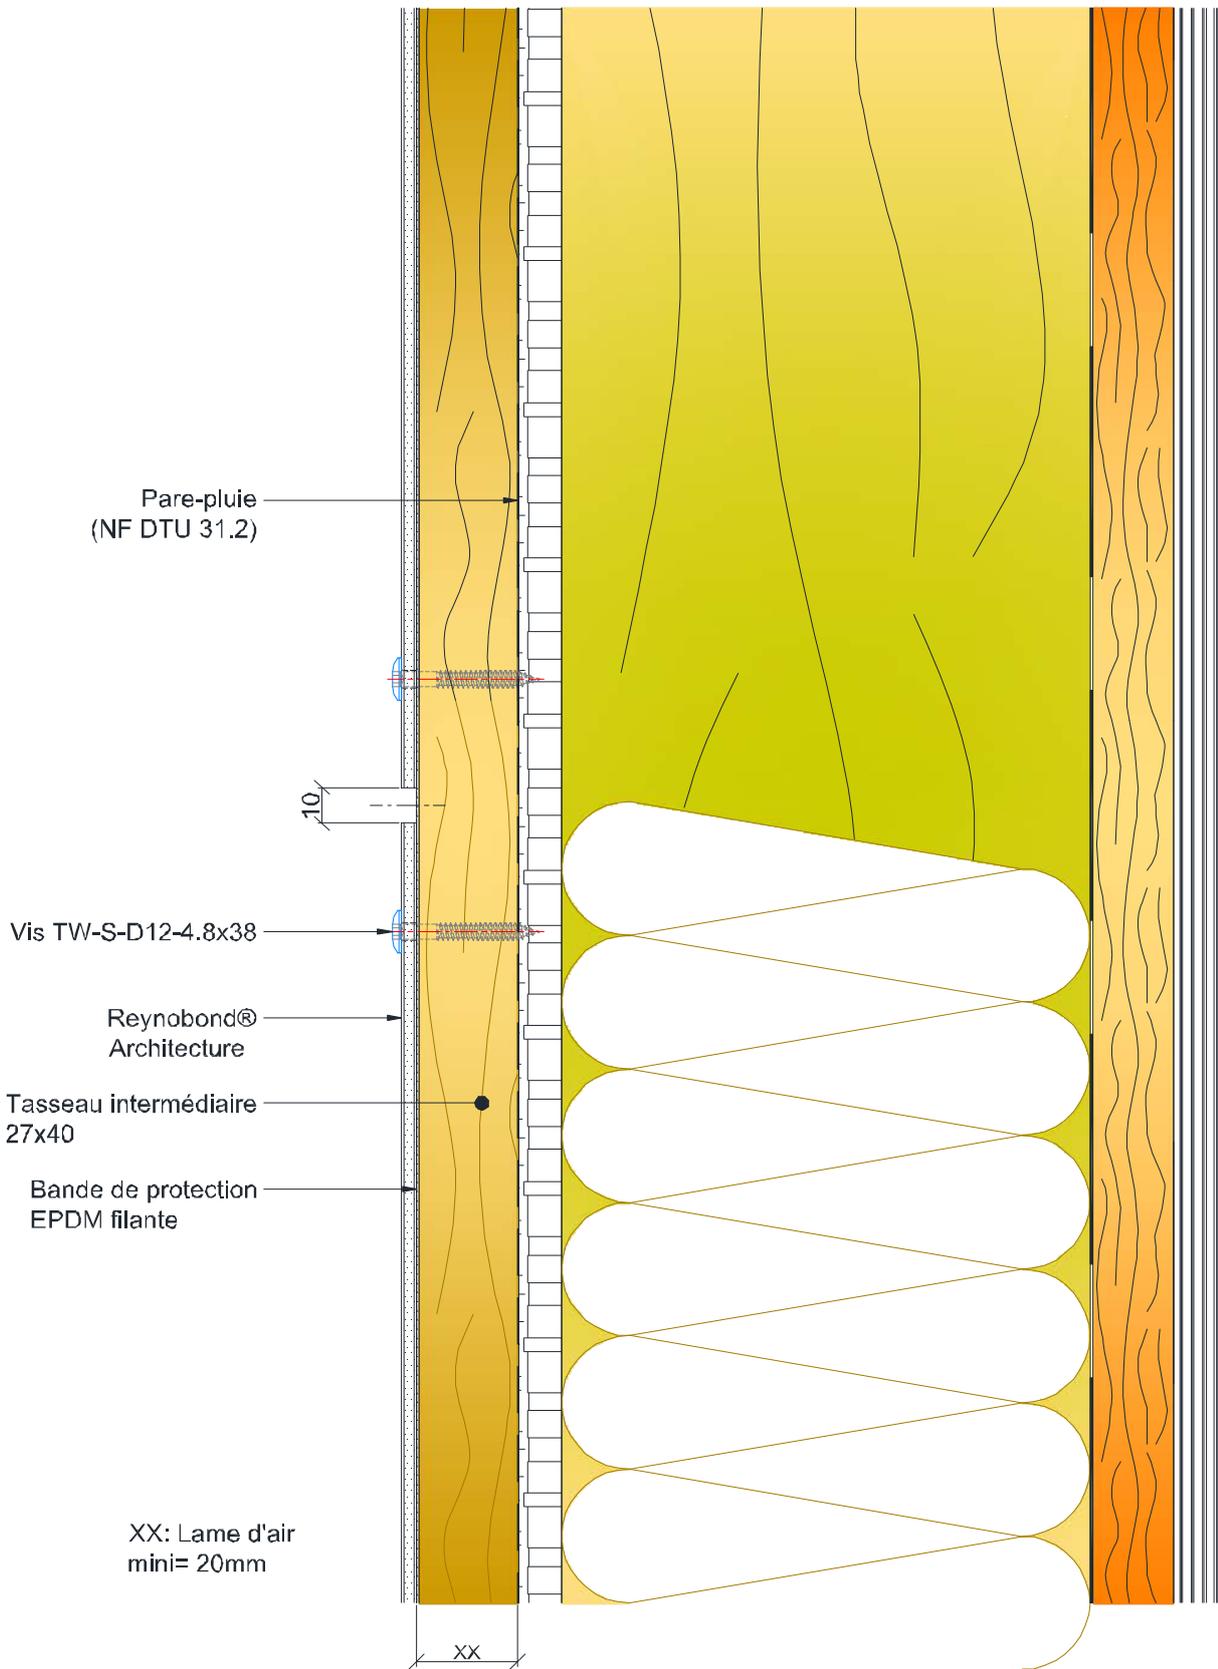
Joint horizontal sur COB (Coupe verticale)
